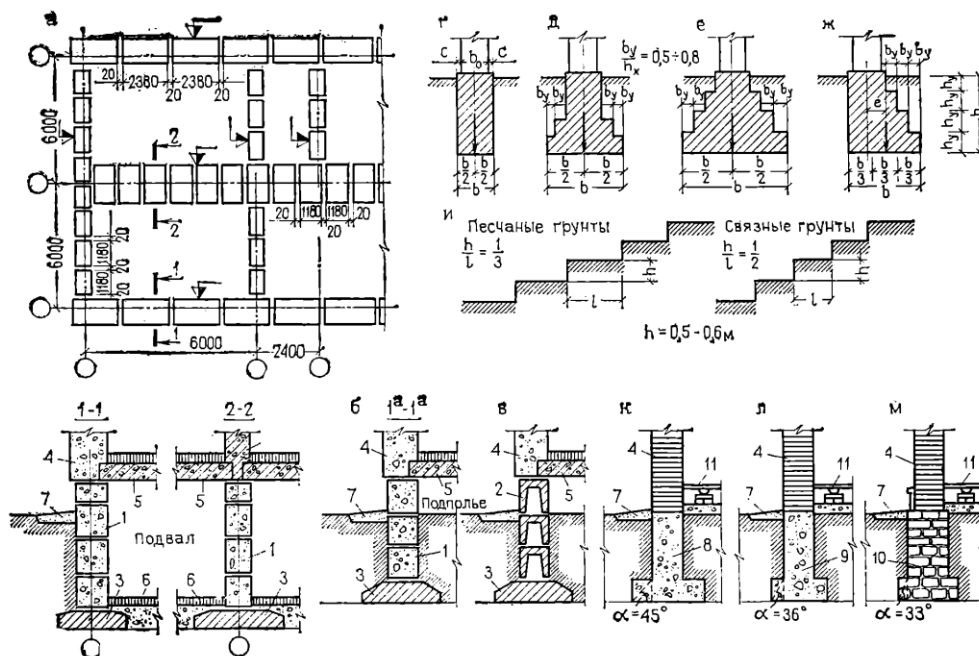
Ленточные фундаменты: а- план и разрез ленточного фундамента из сборных бетонных блоков здания с подвалом; б,в – варианты без подвала из сплошных и пустотелых блоков; в,г, д – конструкции жесткого фундамента с минимальной обычной и максимальной уширенной подошвой; ж – несимметричный фундамент; и – переход от одной глубины заложения к другой; к,л,м – варианты ленточных из монолитного бетона, бутобетона и бута; 1- стеновые блоки подвала; 2- пустотные стеновые блоки подвала; 3 – фундаментные подушки; 4 - стены; 5 – перекрытие; 6 – полы подвала; 7 – отмостка; 8 – бутобетонный фундамент; 10 – бутовый фундамент; 11 – пол первого этажа
